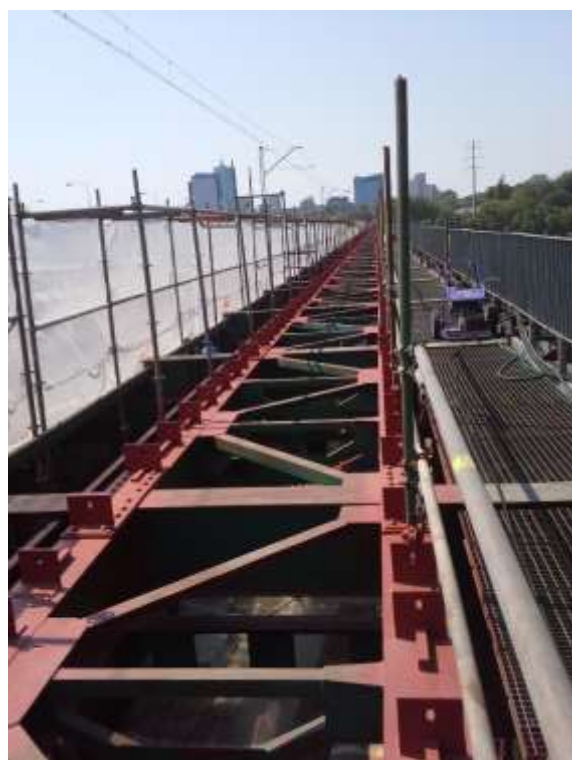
Konstrukcja po aplikacji farby Noxyde
